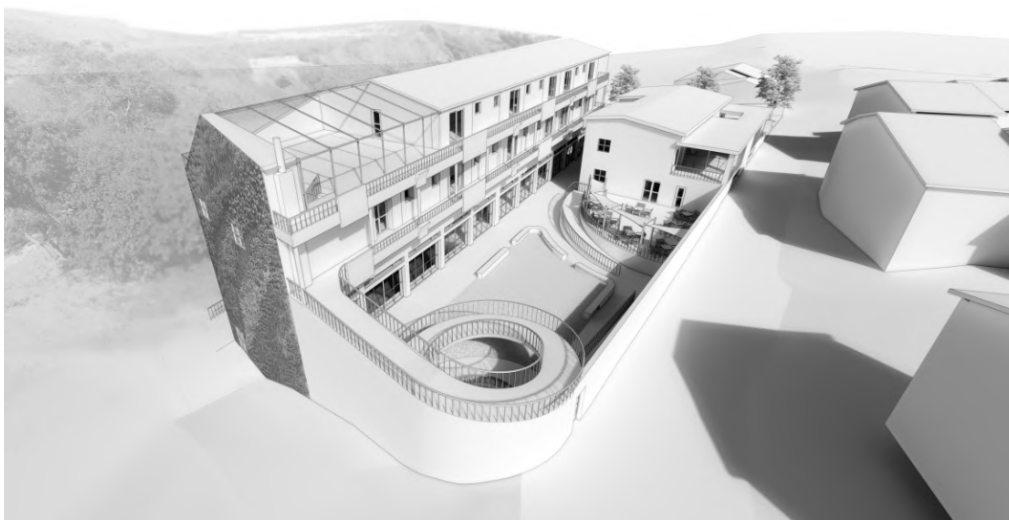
Perspetiva do conjunto edificado com a proposta de Reabilitação - vista Sudoeste.
